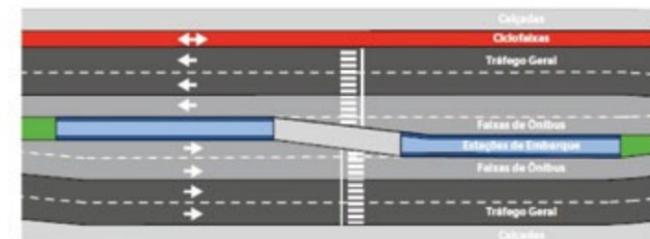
Essa configuração permite a ultrapassagem e garante uma seção transversal menor
